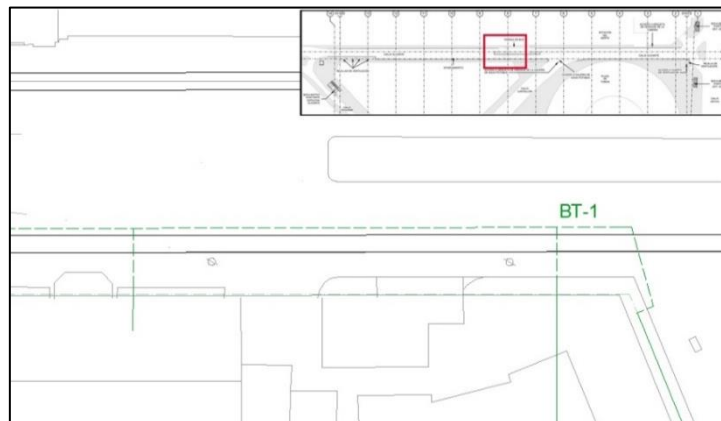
Plano de reposición ELECT-BT-BT1-SR-CX-F9
